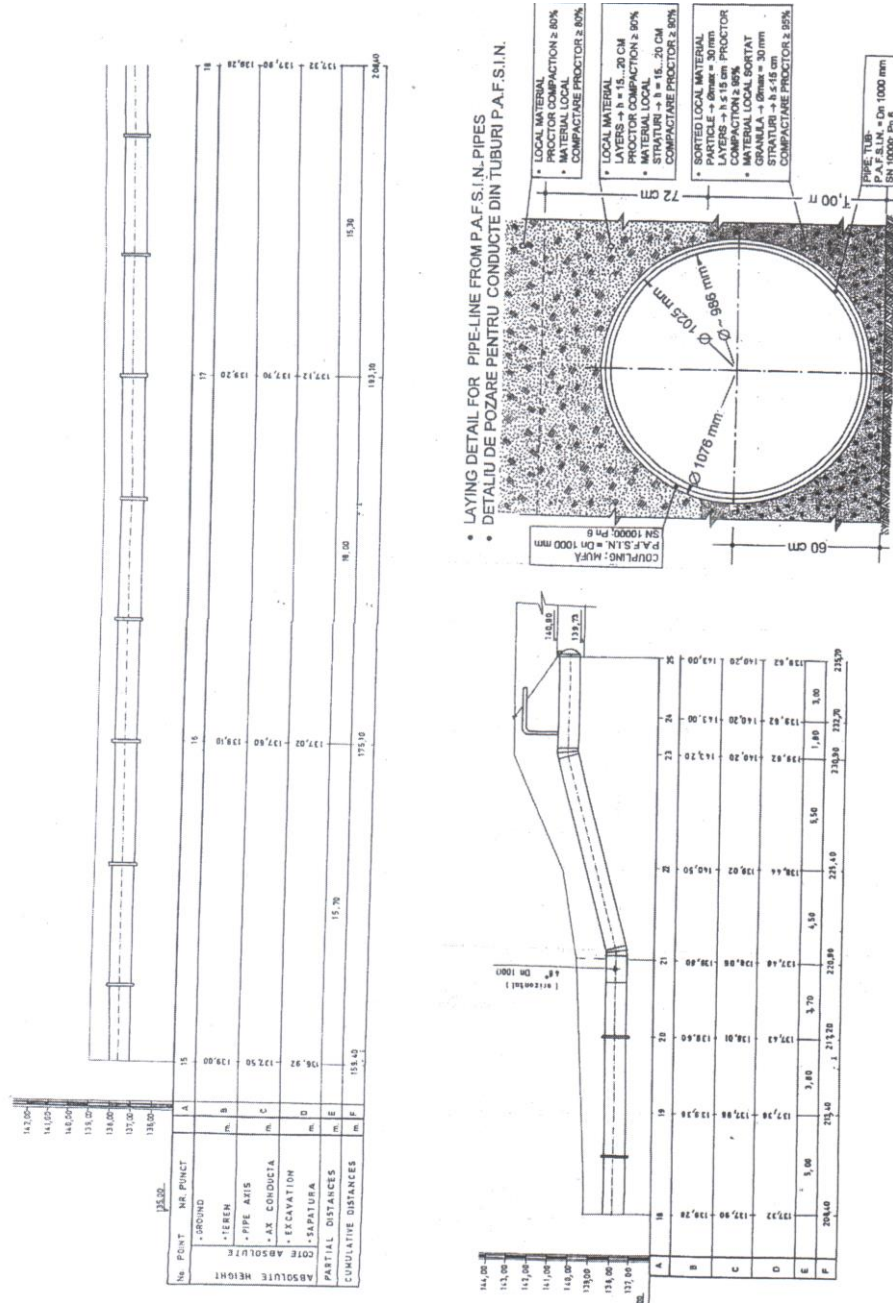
CONDUCTE DE REFULARE – PROFIL LIONGITUDINAL (FILA 3) (S.R.P.) [102]
